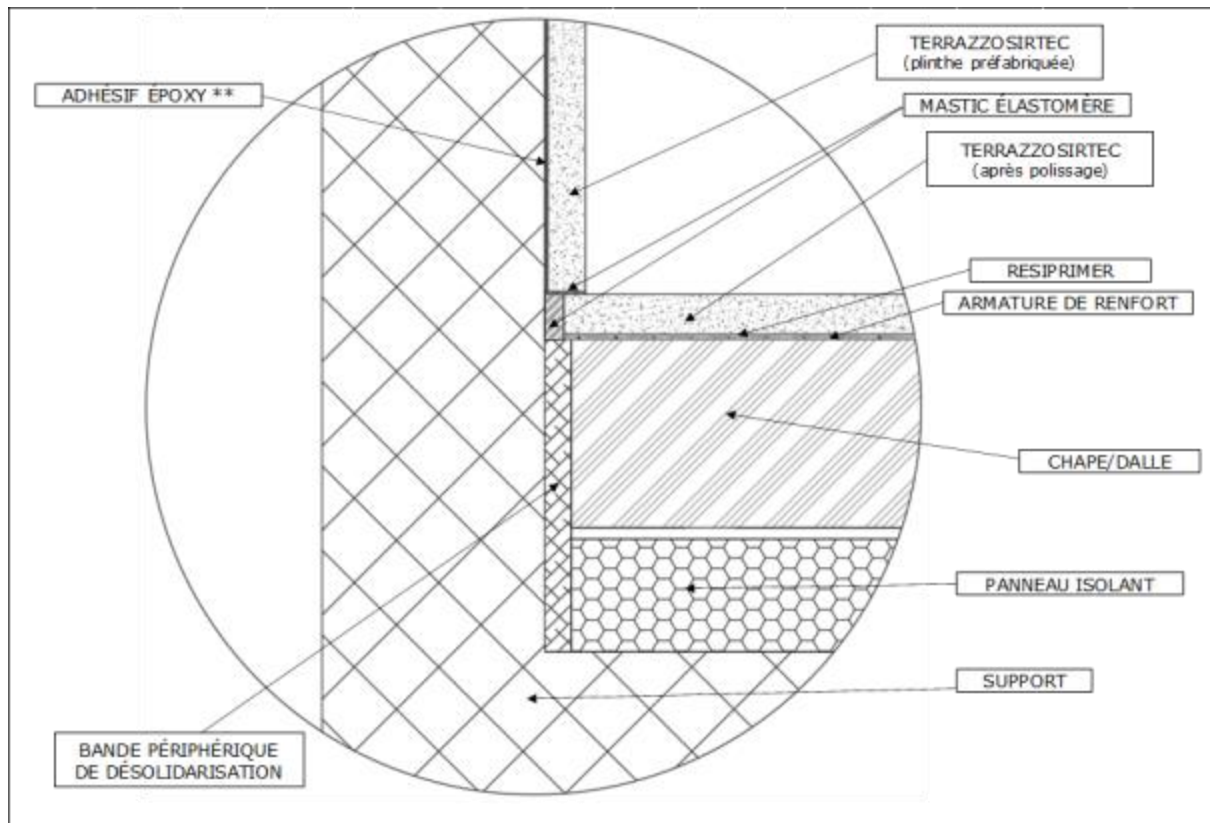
Pièces préfabriquées et seuils (niveau différent)
